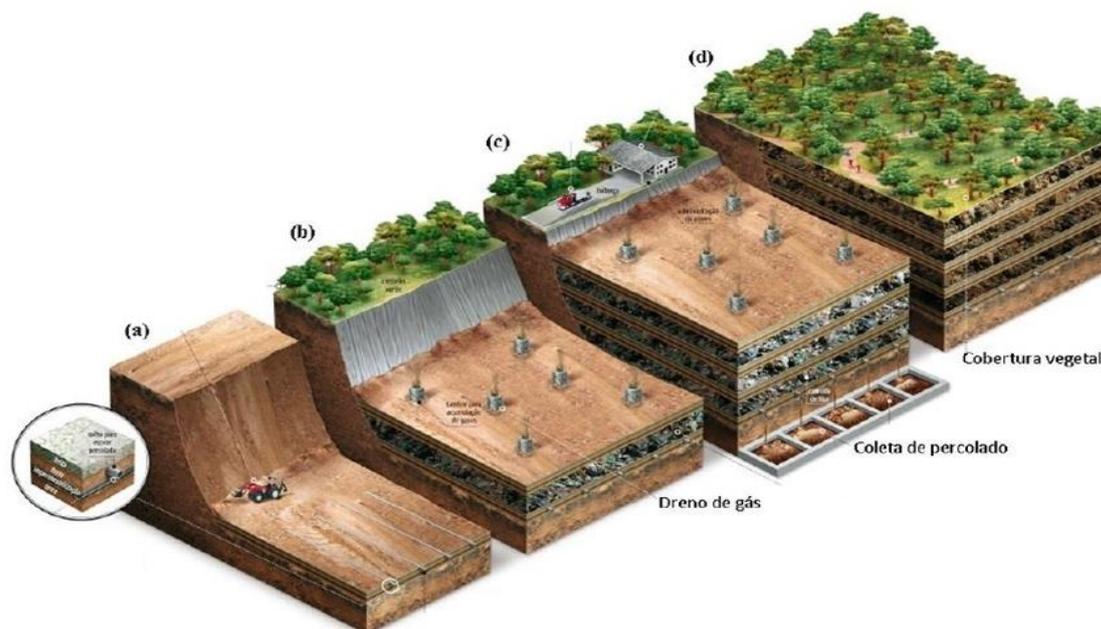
Esquema de construção de aterro sanitário: (a) vista inicial com o terreno escavado e compactado, drenos de lixiviado e manta de proteção; (b) vista após a primeira camada de lixo, com inserção de drenos de gases; (c) vista com várias camadas fechadas e os tanques de coletas de lixiviado e (d) aterro encerrado.
